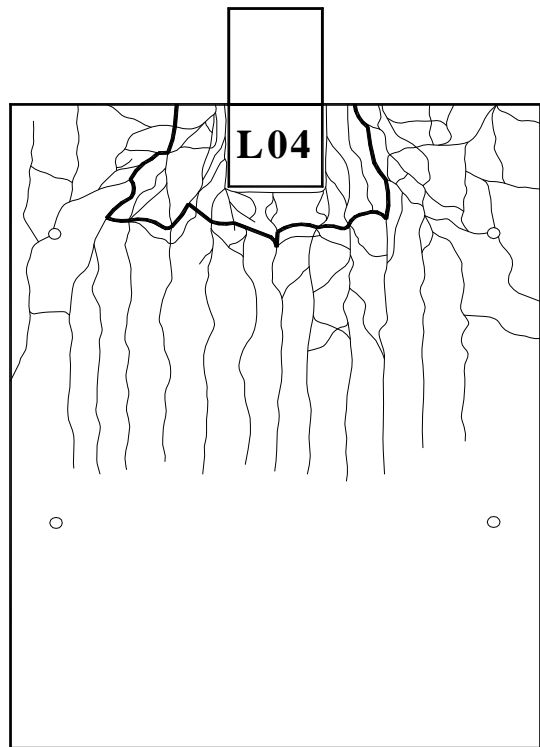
Padrão de fissuração da face superior da laje – L4
